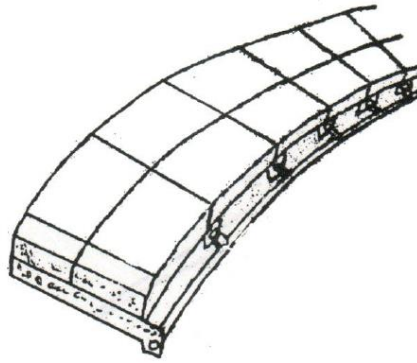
Drenes transversales conectados a un dren longitudinal
